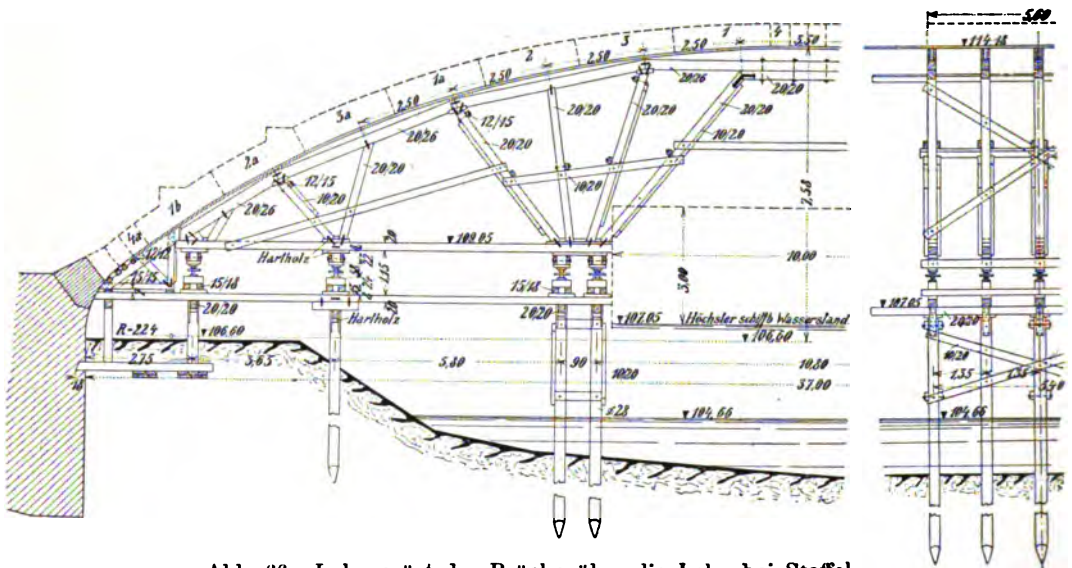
Lehrgerüst der Brücke über die Lahn bei Staffel.
